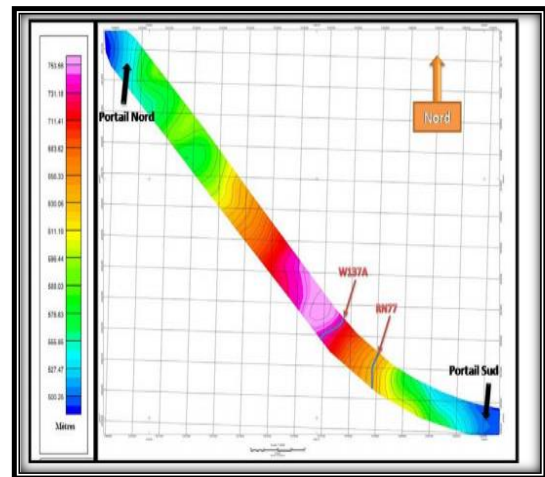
Vue en plan de pentes Au-dessus du tunnel
